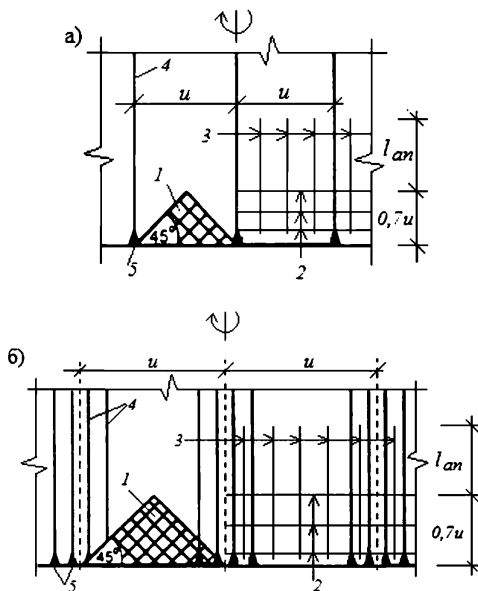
Зоны установки дополнительной продольной и поперечной арматуры для одиночных арматурных элементов (а) и для группового размещения арматурных элементов (б):
